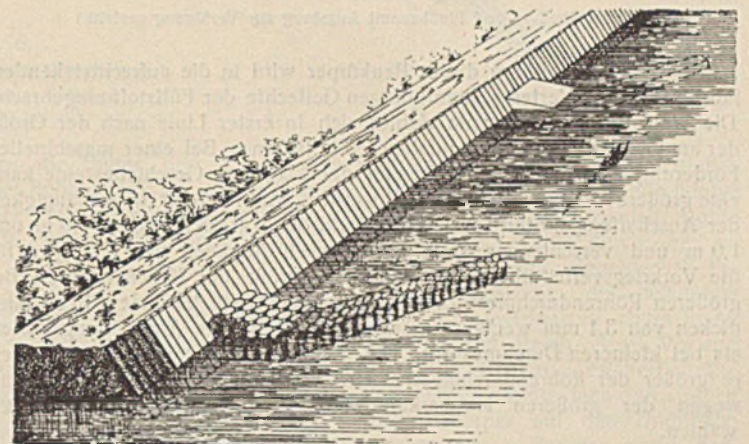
Bühnentyp nach Serrazanetti (Tauchbühne).
